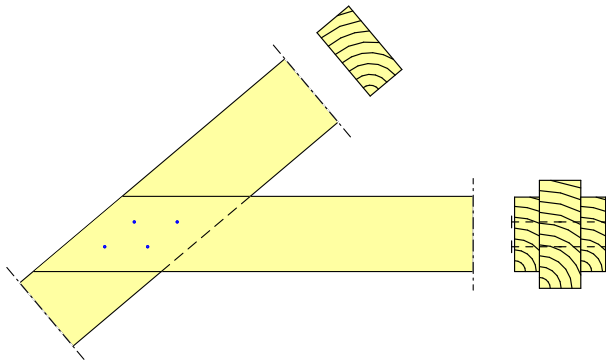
Anschlussdetail zweiteiliger Kehlbalcken an Sparren
